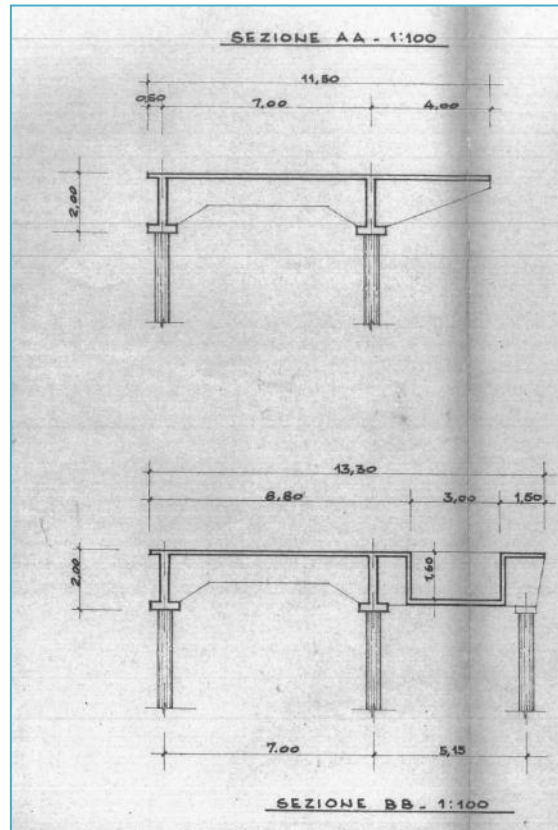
Sezioni A-A e B-B dell'impalcato esistente (tratta da progetto originale 1968)
